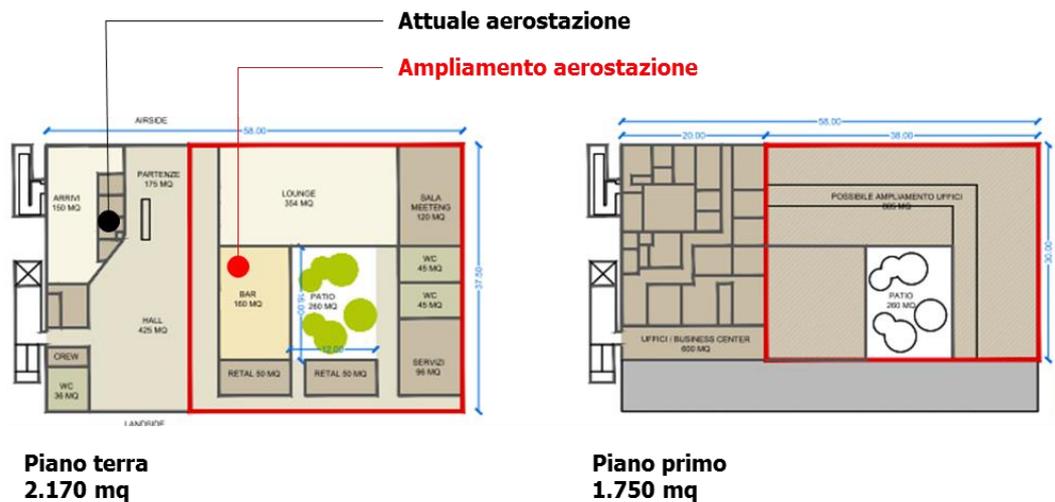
Aerostazione Aviazione Generale: pianta e distribuzione degli spazi interni piano terra e primo piano
